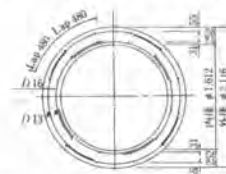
鉄筋組立断面図 図-8 鉄骨組立断面図
